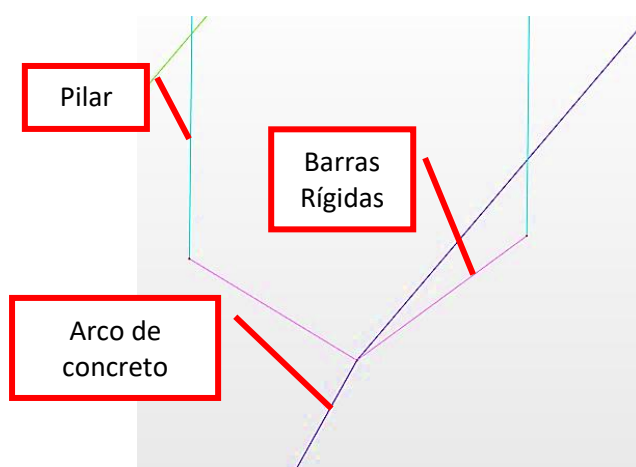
Barras rígidas ligando os pilares e o arco de concreto (Arquivo do Autor).
